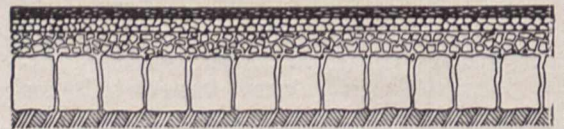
Zweischichtiger Walzasphalt mit aufgerauhter Oberfläche.
